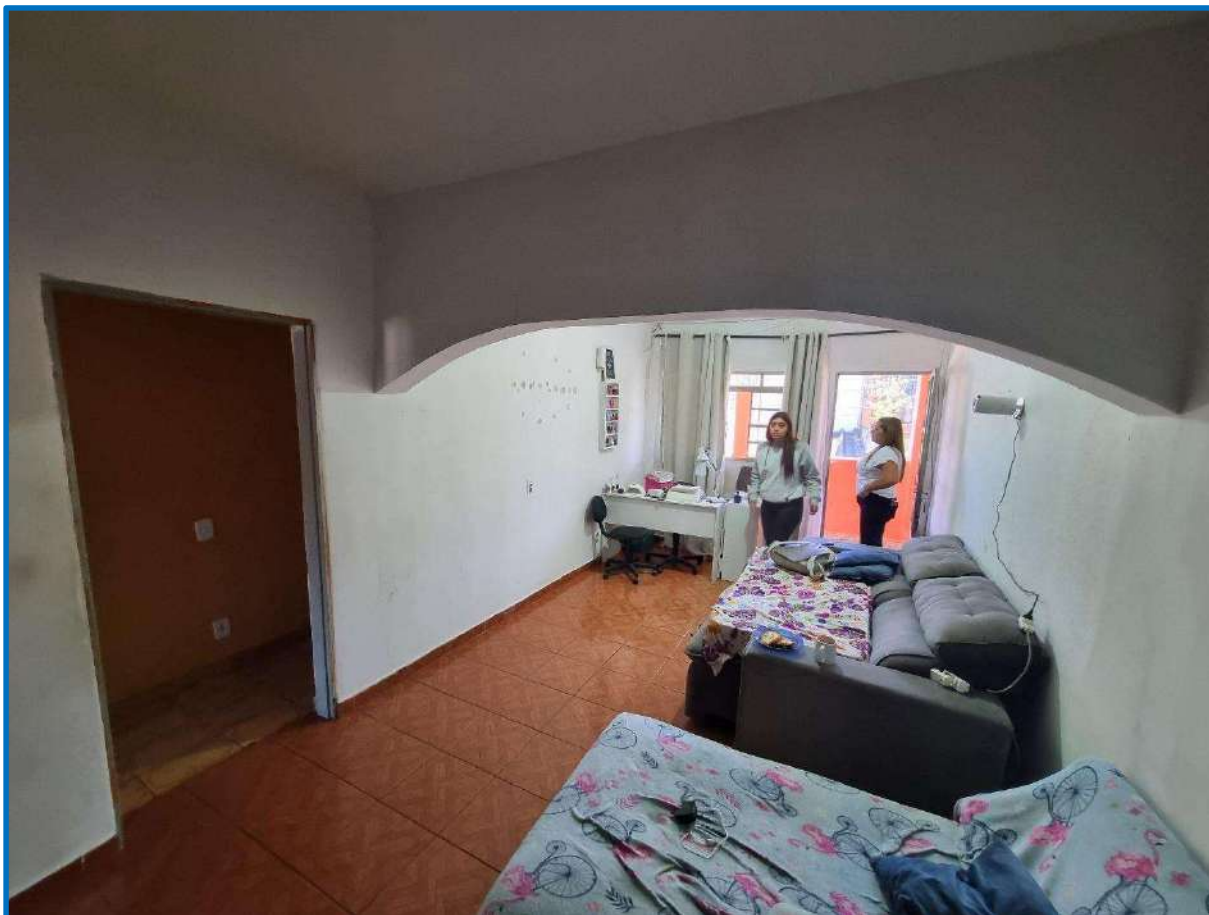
Vista geral do dormitório 2 do pavimento inferior.
